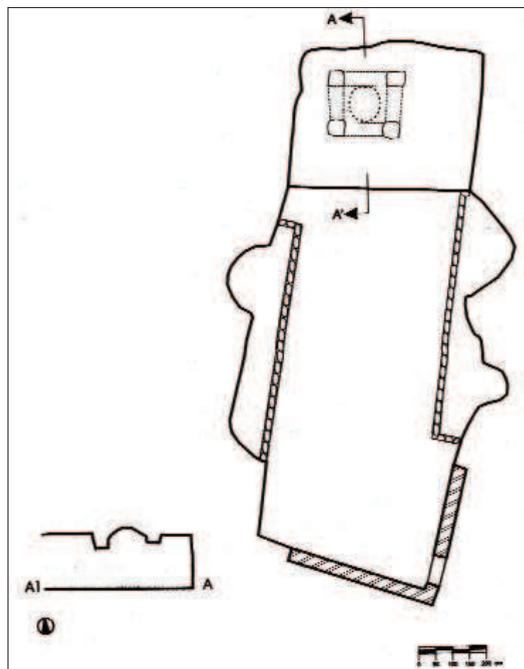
Cava Grande, Cansisini. Planimetria e sezione longitudinale del recesso con baldacchino dell'ipogeo B
